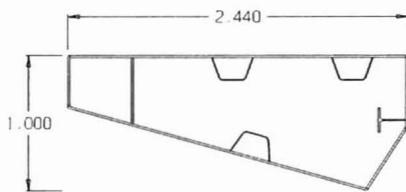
Sección transversal del tablero en las rampas de acceso.
